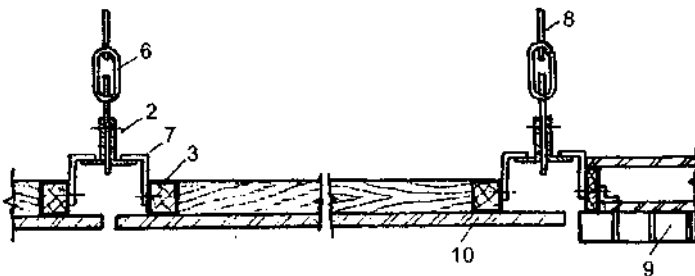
8 Подвесной потолок с креплением плит с помощью крепежных уголков:
